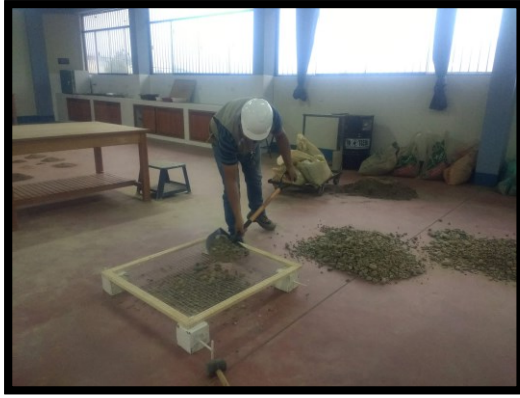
Obtención de las piedras de drenaje mediante Tamizados – experimentación
